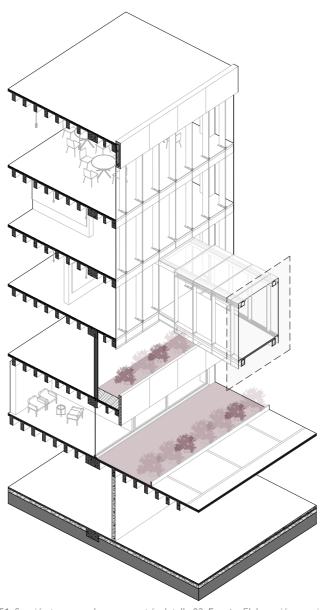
Sección transversal y axonometría detalle 03. Fuente: Elaboración propia.
